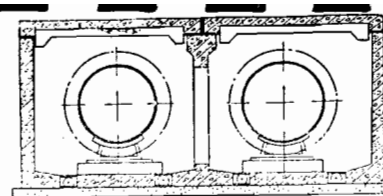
Теплопровод в железобетонном сборном непроходном канале.
